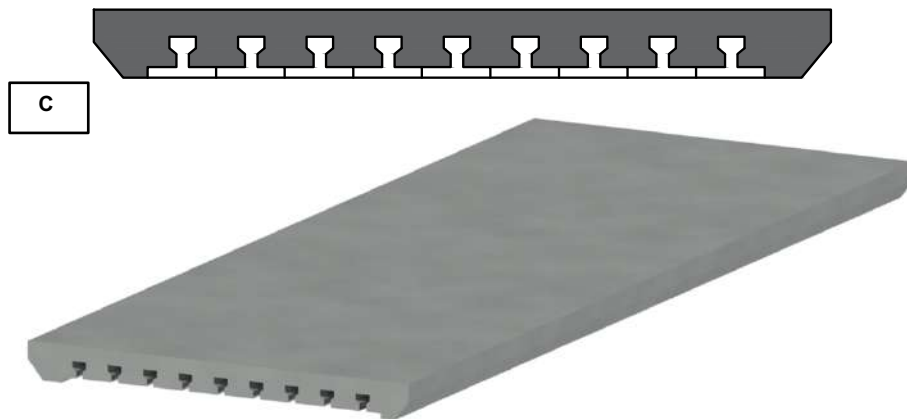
Laje maciça de concreto armado sobre vigotas pré-moldadas. Fonte: autoral
